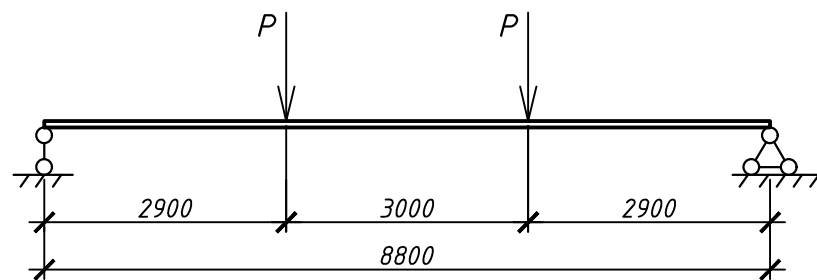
Схема испытаний балок БСП 9–...S800
